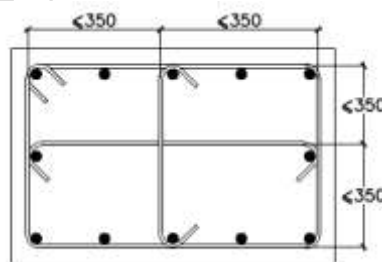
Distancia máxima entre ramas del refuerzo transversal
